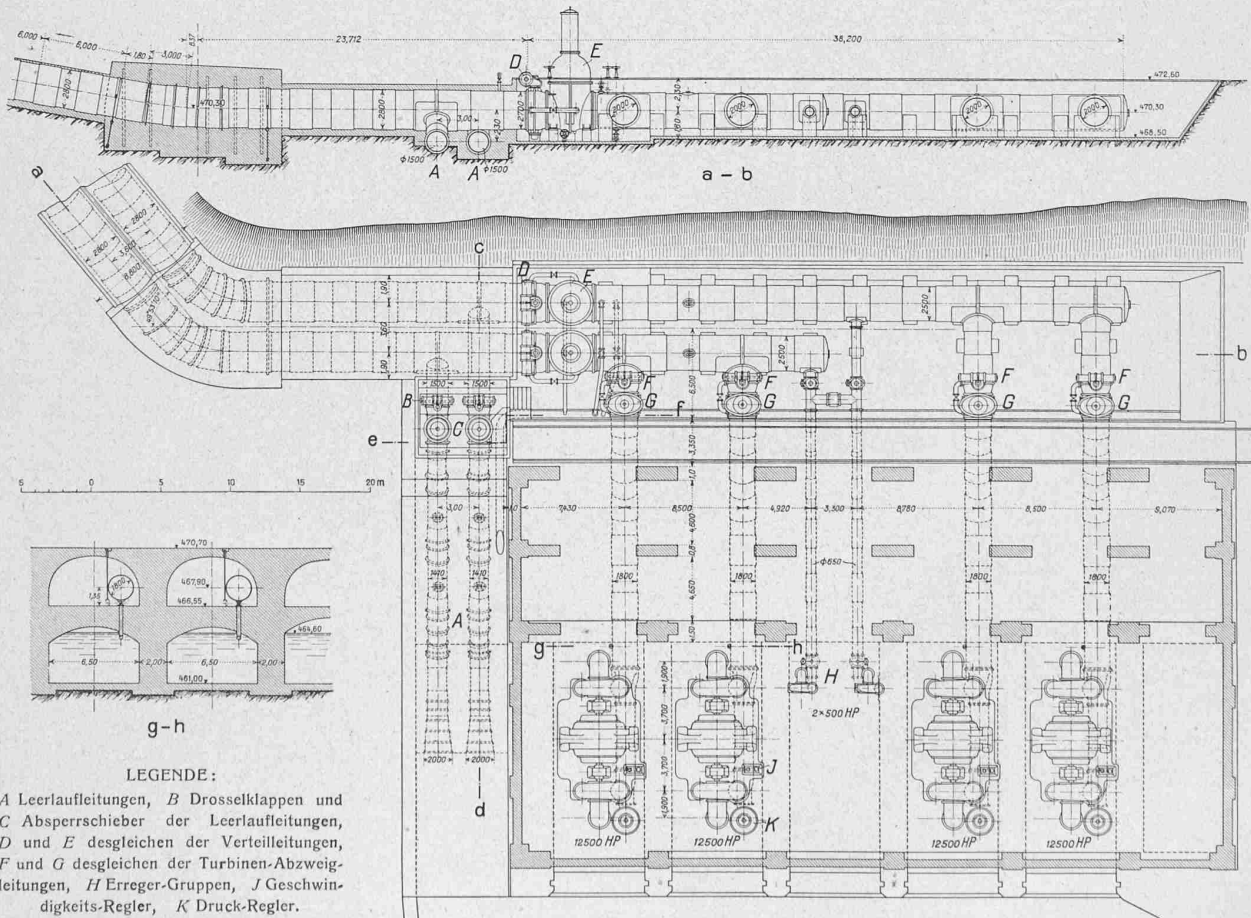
Verteil- und Leerlauf-Leitungen mit Grundriss des Maschinenhauses; Schnitte a-b und g-h. — Masstab 1: 500.
